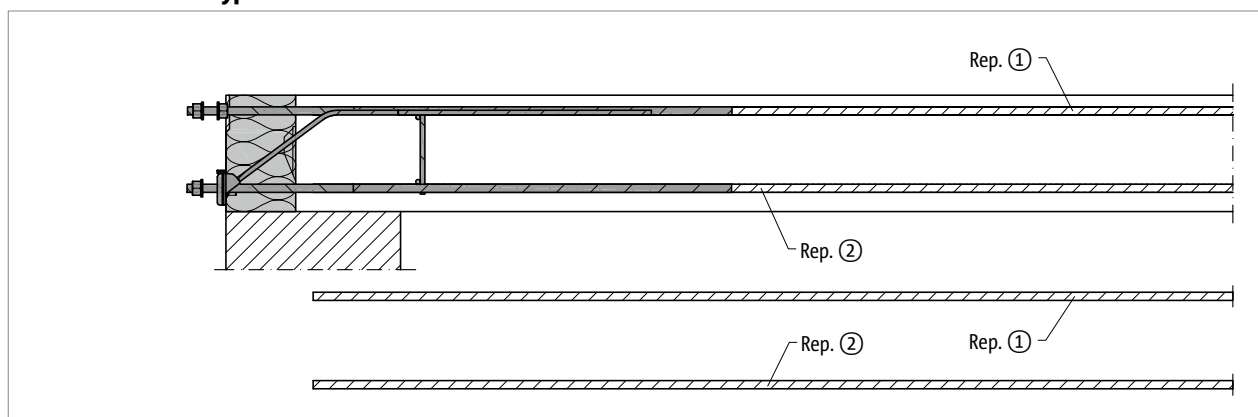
Schöck Isokorb® XT type SK-MM1-VV1 : armatures à prévoir par le client, vue en coupe
